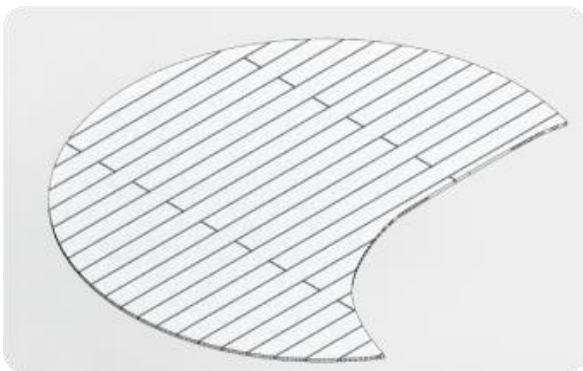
Entablado en madera plástica, primer nivel de plataforma.
